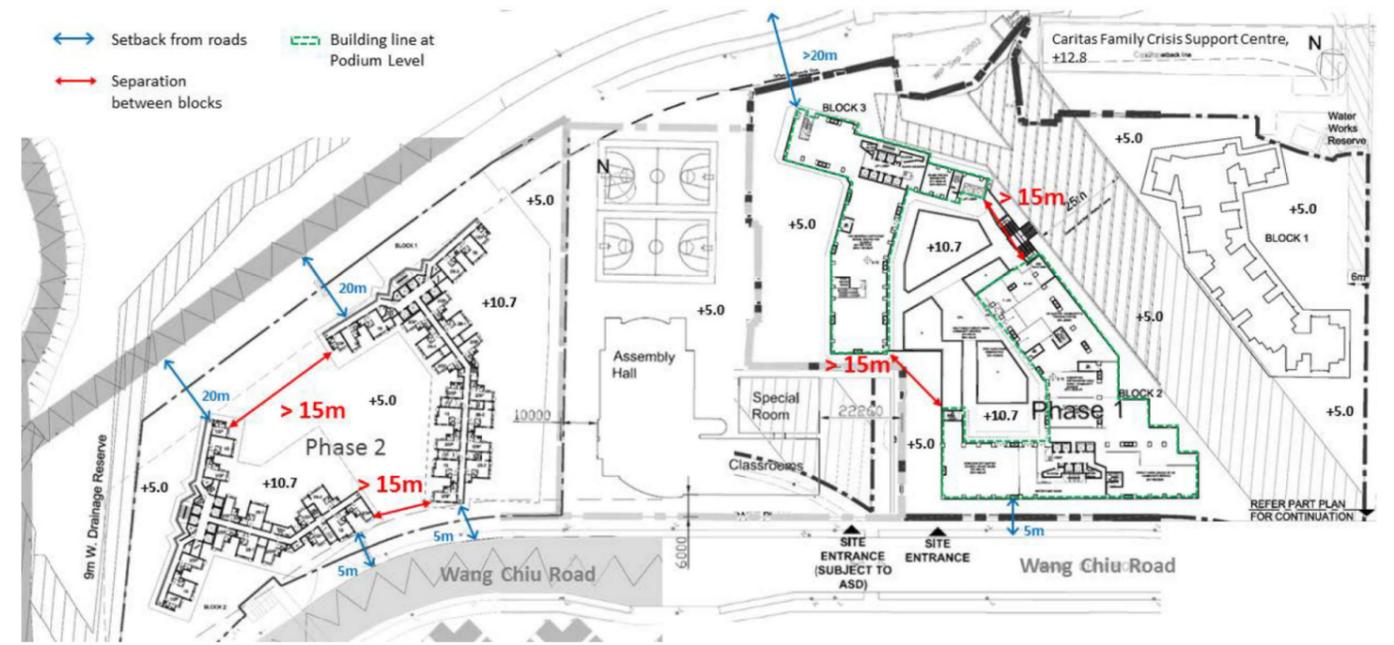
住宅大樓設計特點 Design Features at Domestic Towers
